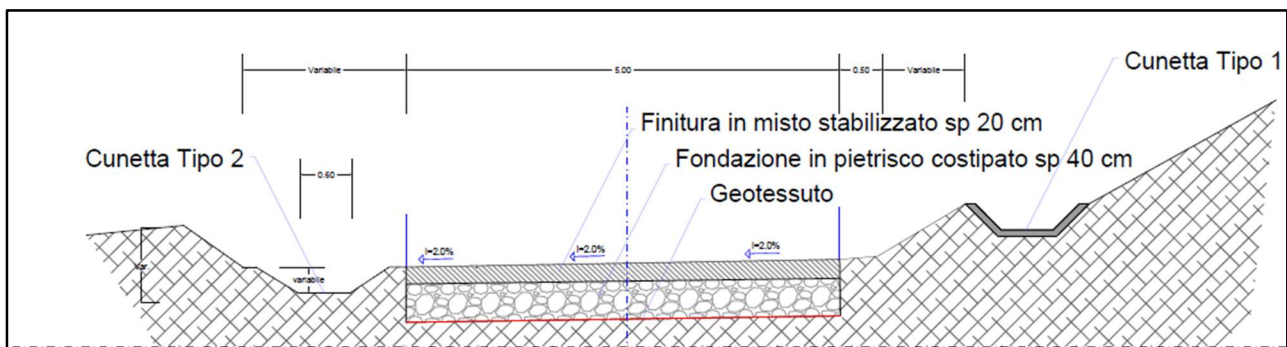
Sezione tipo viabilità con drenaggio a monte e a valle
